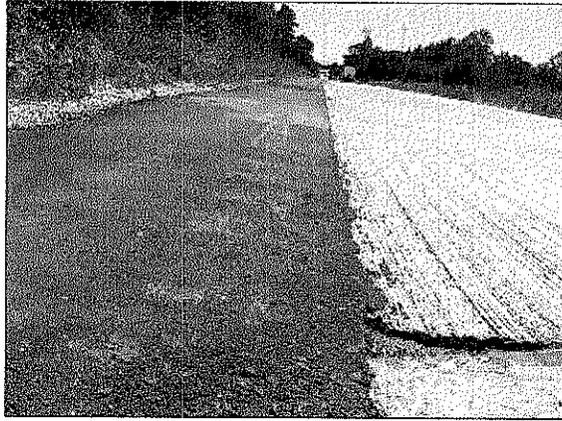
Pavimento quebrado en junta transversal en Ruta T-205.
